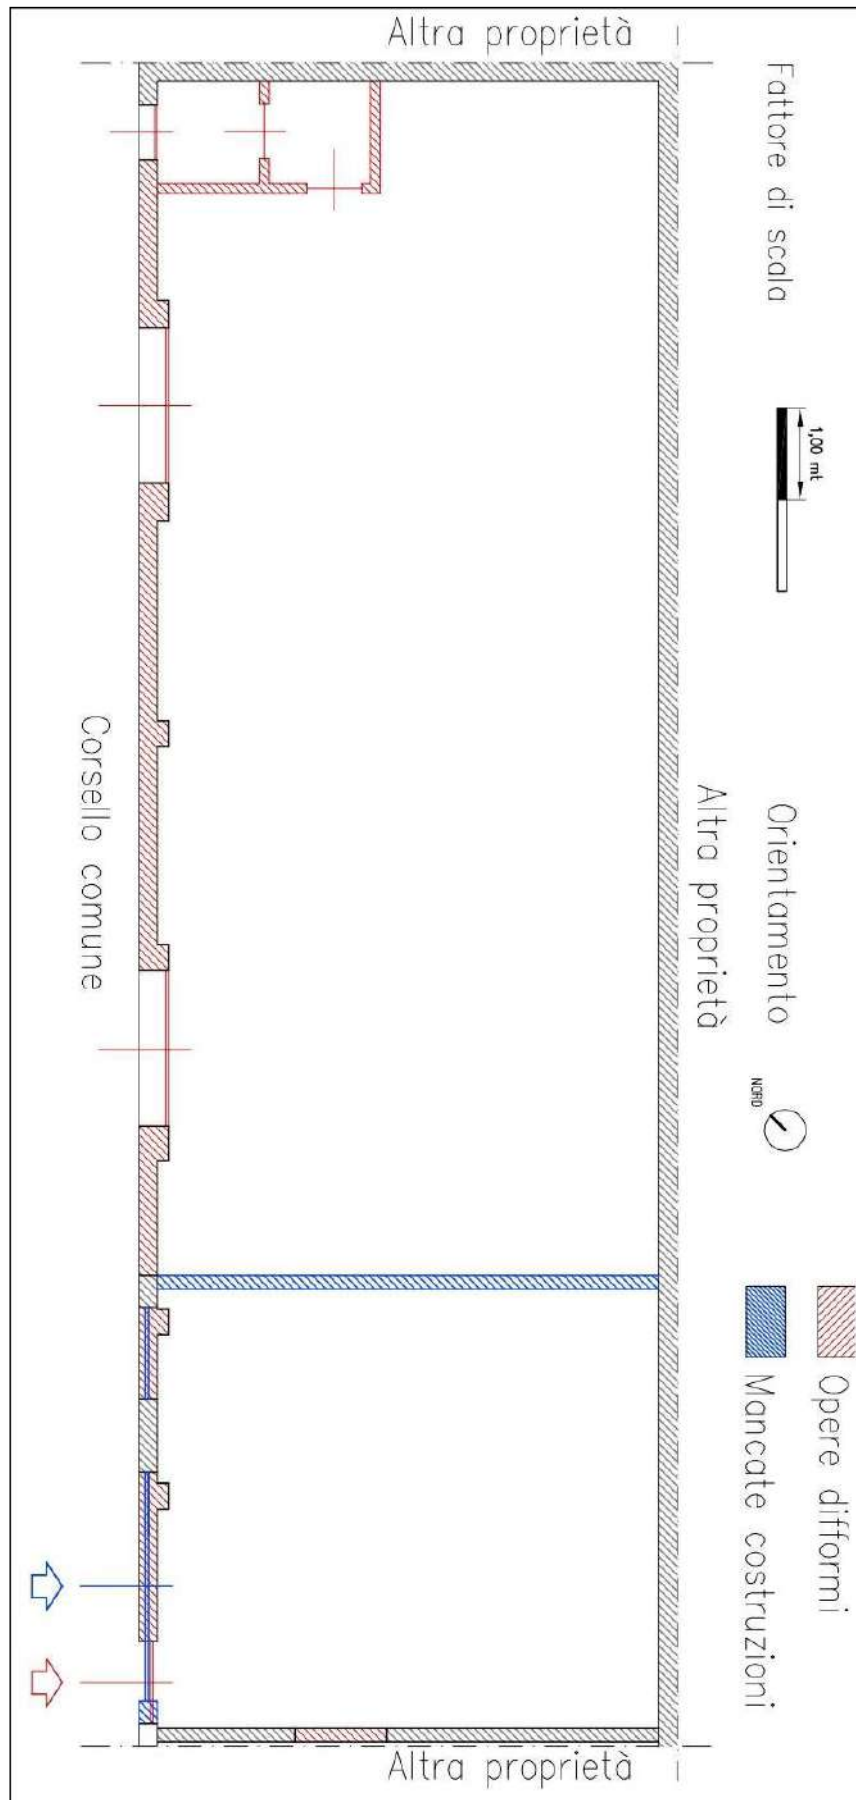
Pianta di confronto dell'immobile oggetto di perizia con tavola accatastamento
